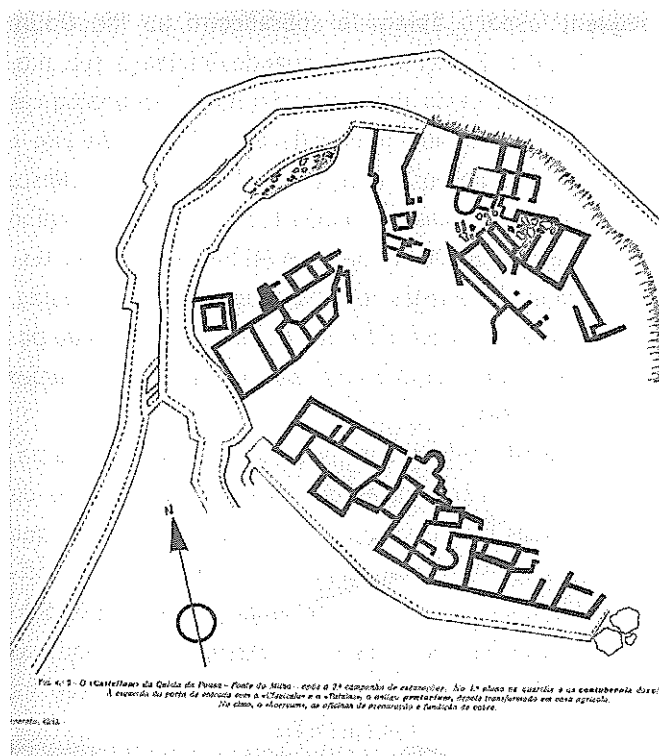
| Planta da villa da Fonte do Milho segundo Russel Cortez
